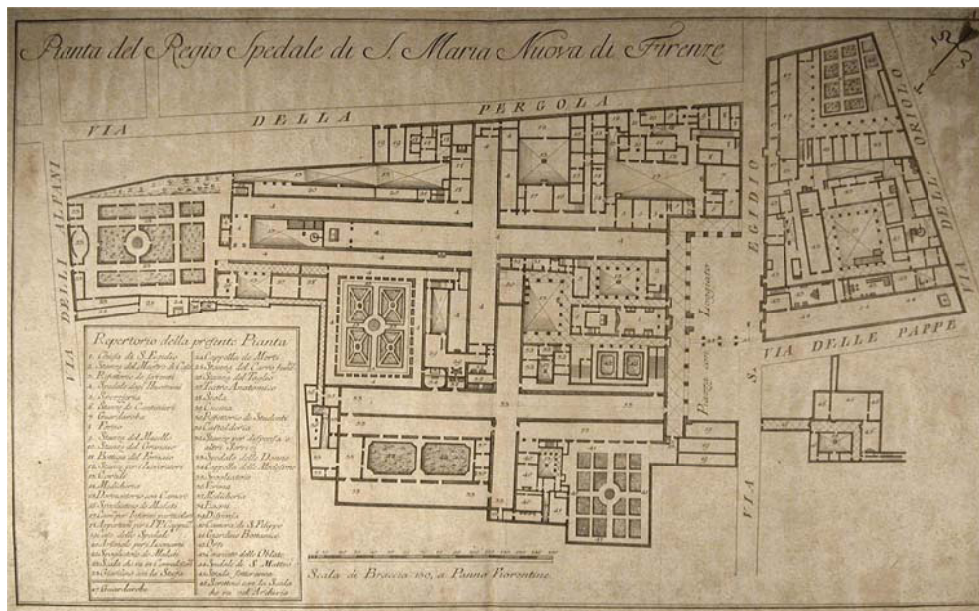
Pianta dell' Ospedale S Maria Nuova a Firenze.
